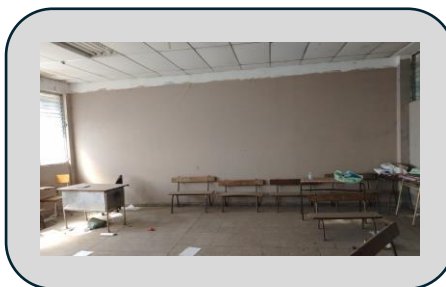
Esquema de daños en pared de mampostería de ladrillo de barro, tercer nivel, eje 5-5, tramo A-B.
